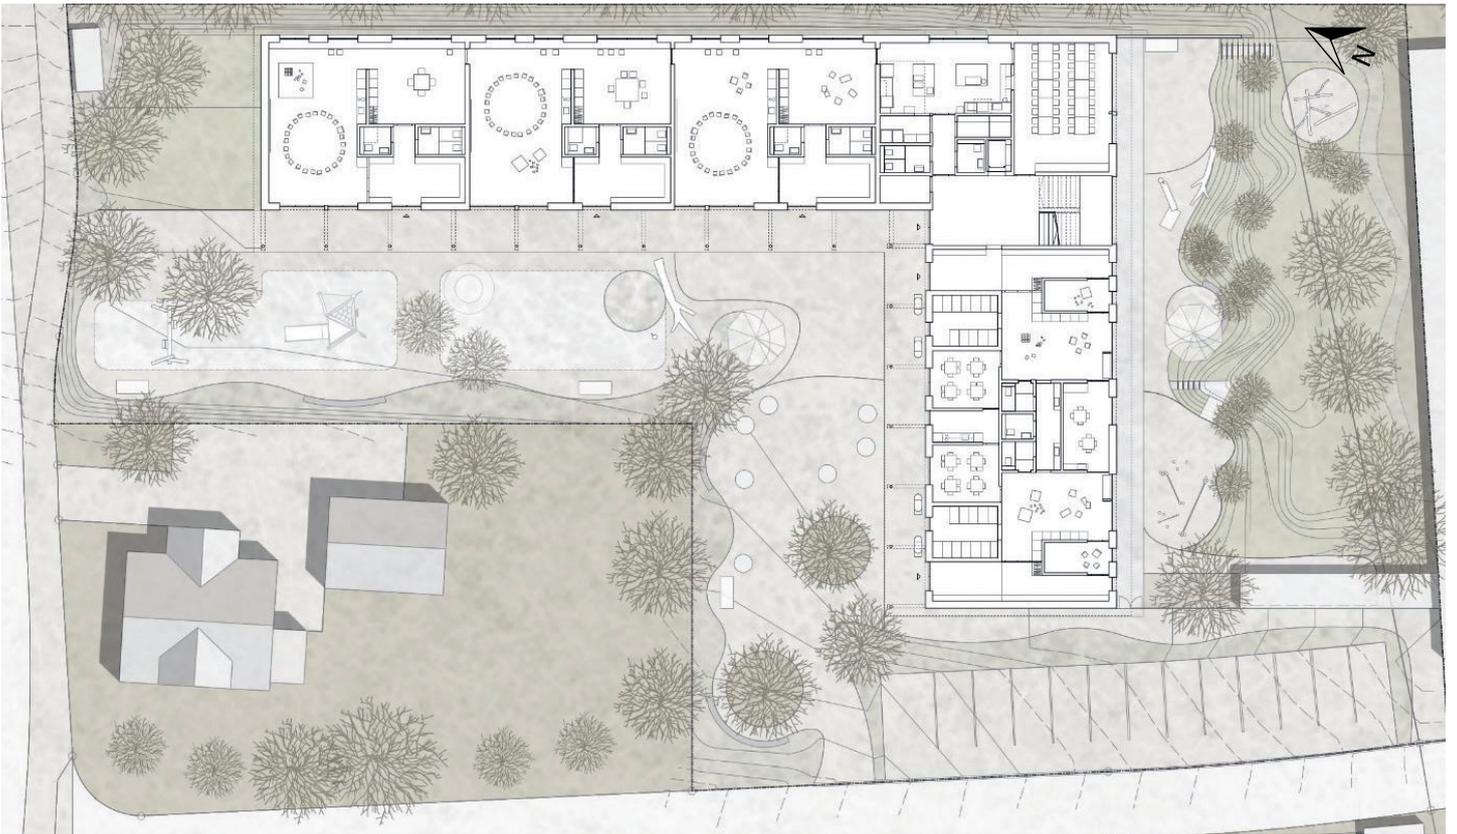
Grundriss Erdgeschoss / Umgebung
